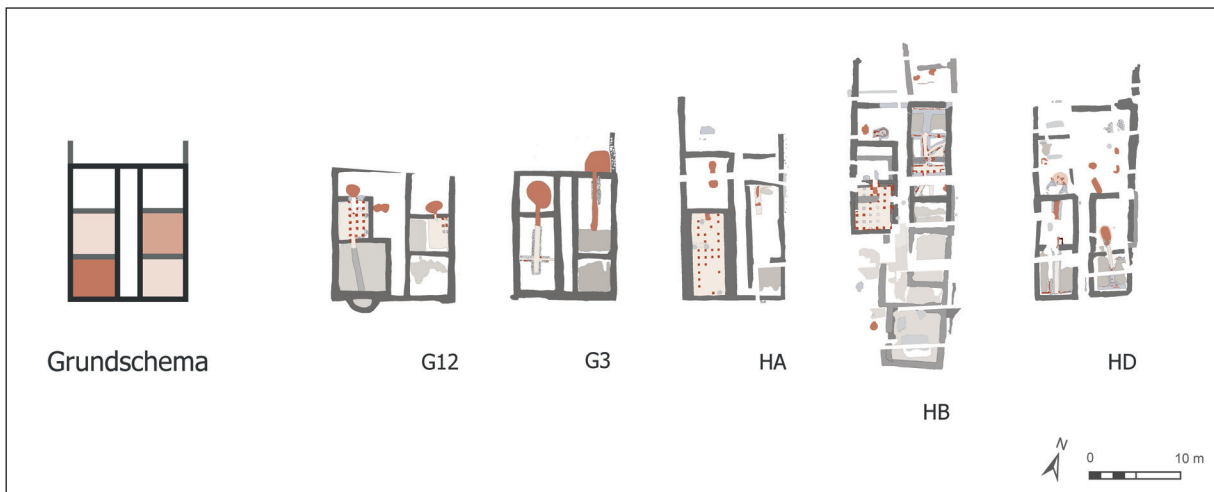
Zusammenstellung der Gebäude mit sich wiederholendem Grundrisschema in der Zone A 3 (E. Thysell).
